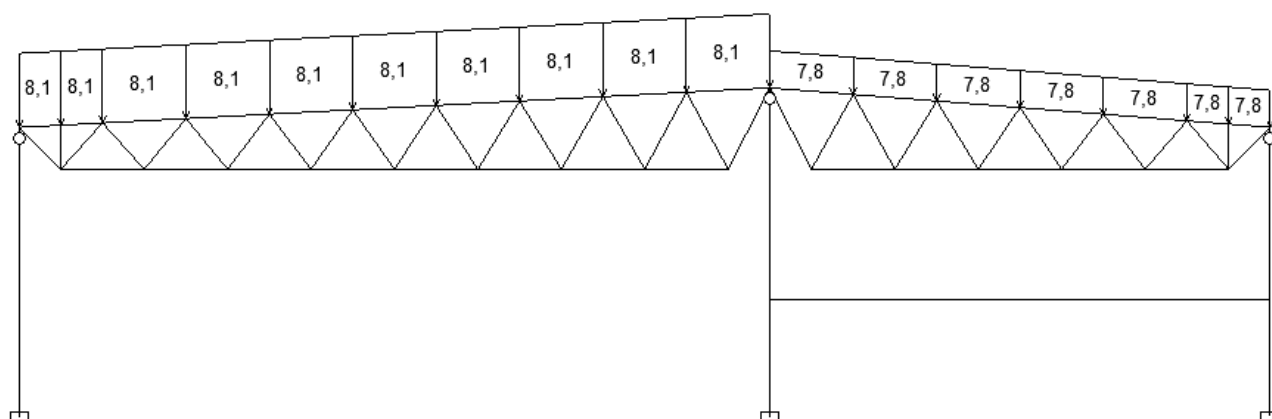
Схема загрузки от снеговых нагрузок
